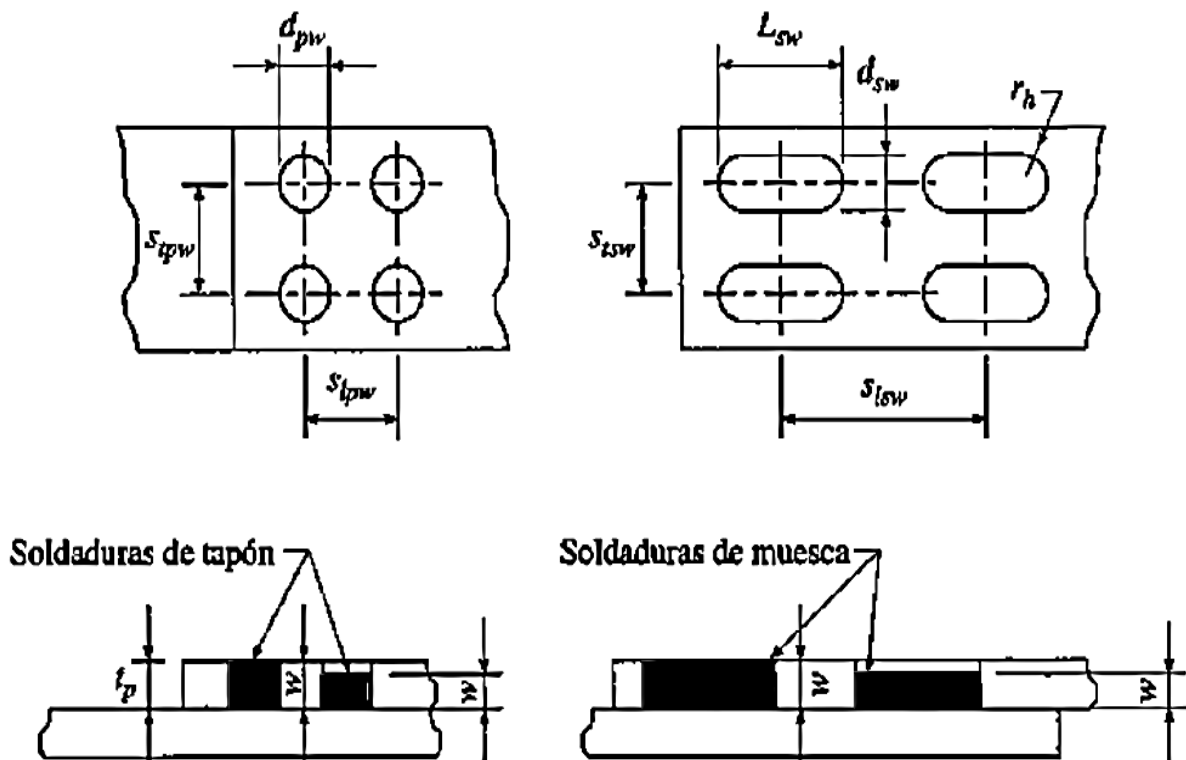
Valores geométricos en soldaduras de tapón y muesca
